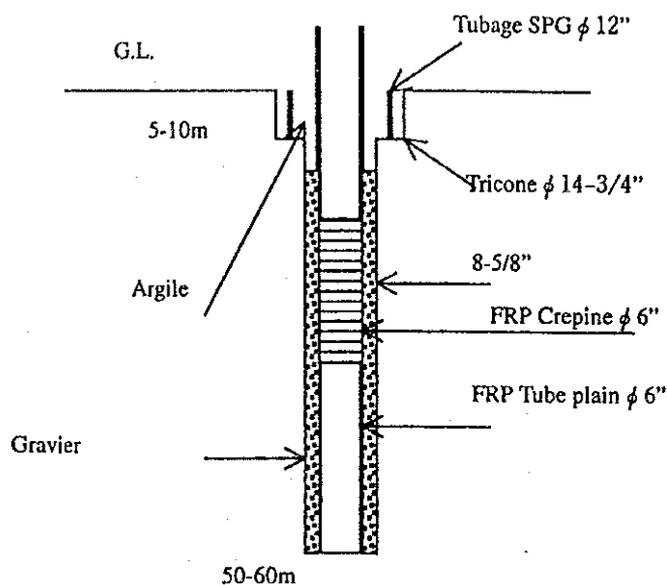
Structure standard d'un forage pour le plan d'alimentation en eau de l'horizon 2015
